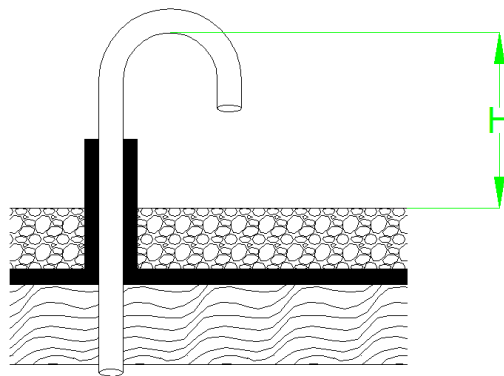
Dacheinführung PV-Anlage mit Syphon
